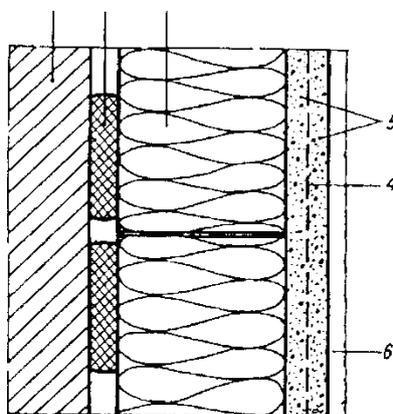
Конструкция стены с наружной теплоизоляцией с оштукатуриванием плитного утеплителя:
